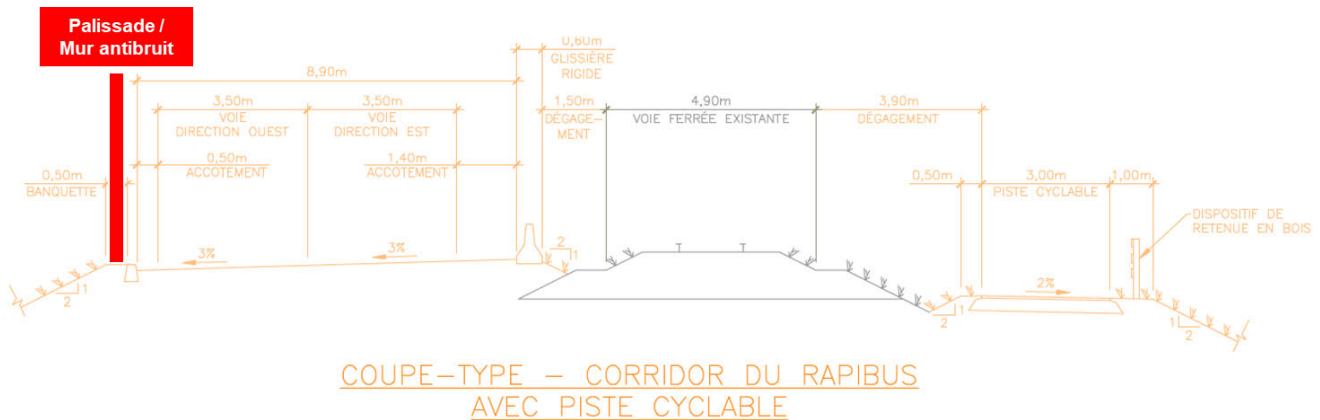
Coupe type avec l'ajout d'une palissade / mur antibruit
